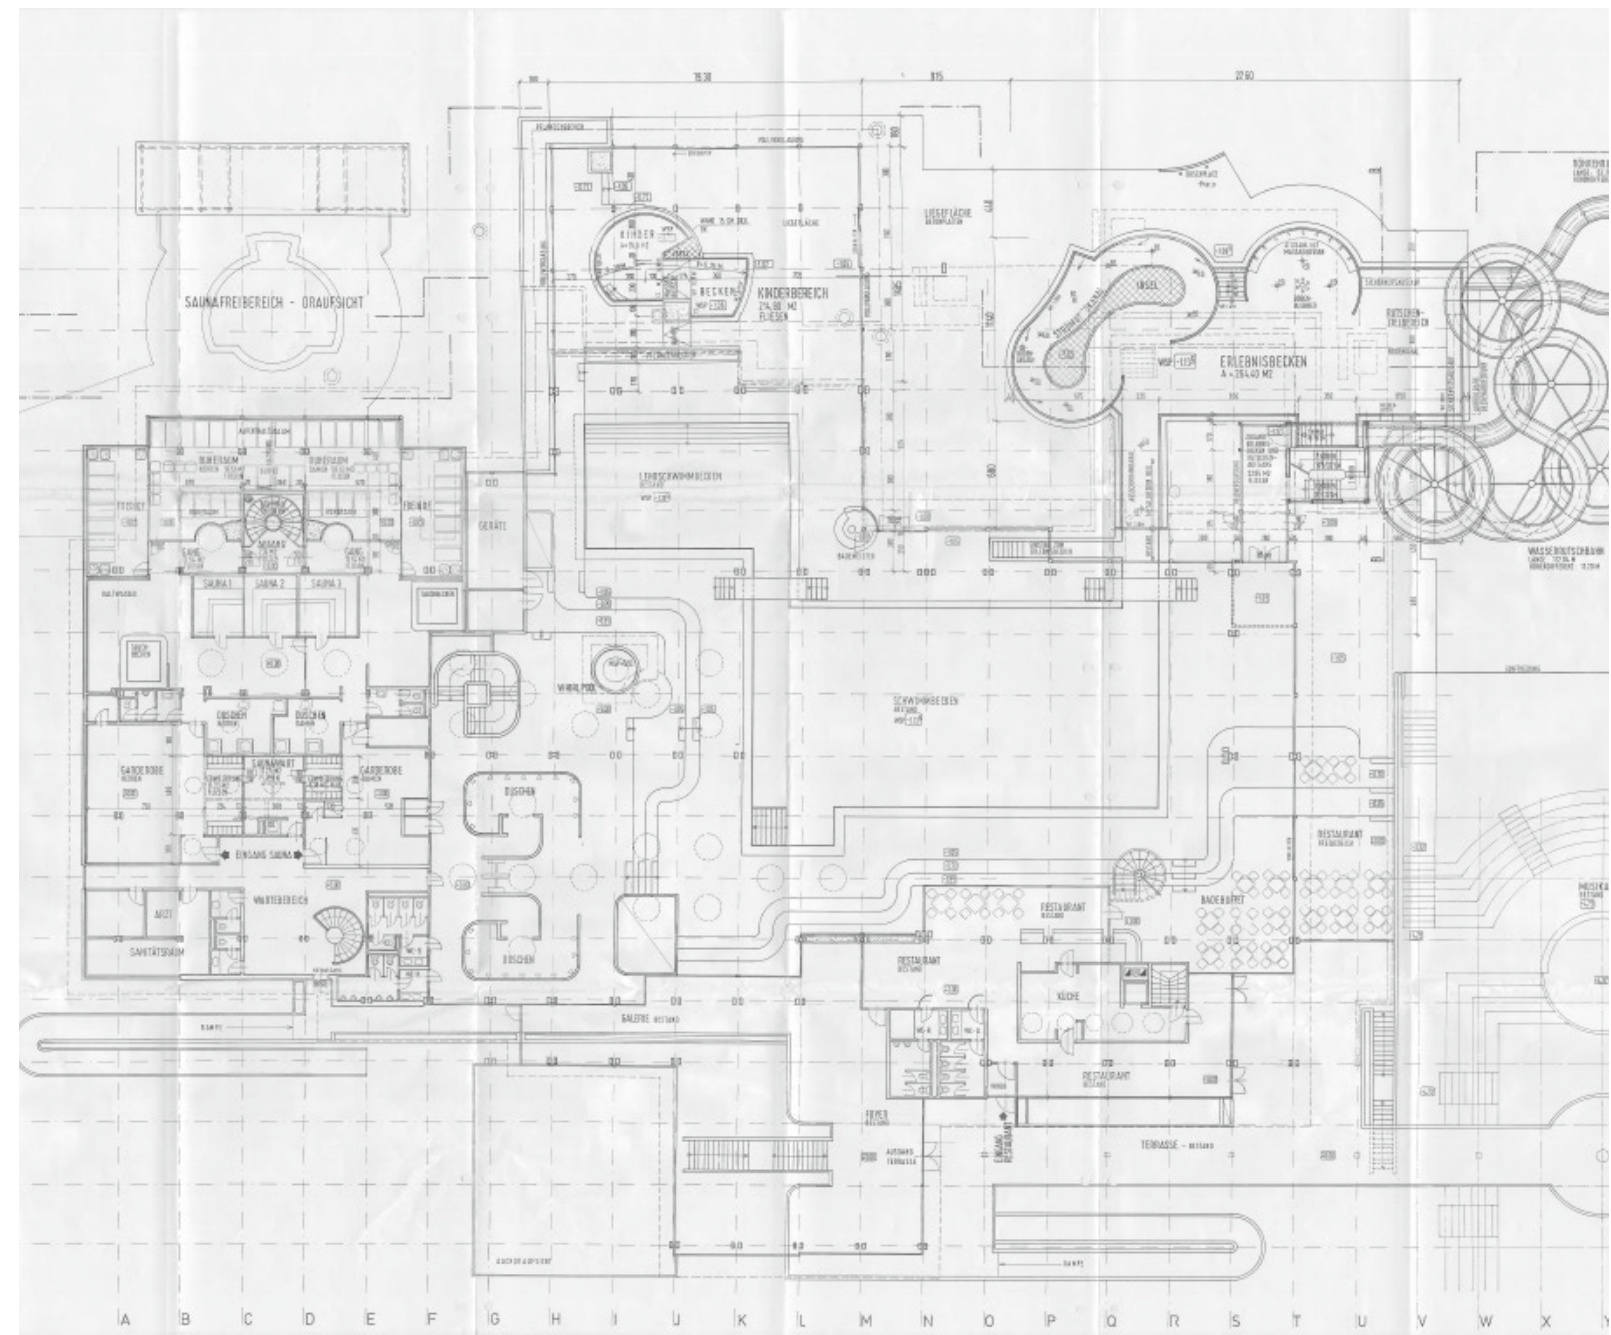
Grundriss Obergeschoß, Einreichplan 1995
